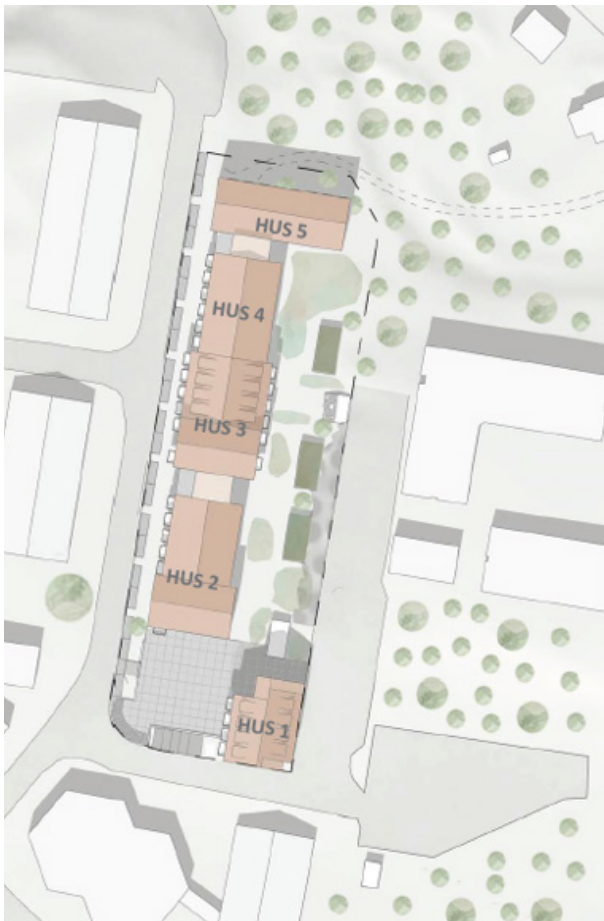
Illustrationsplan över planområdet med ny föreslagen bebyggelse.
